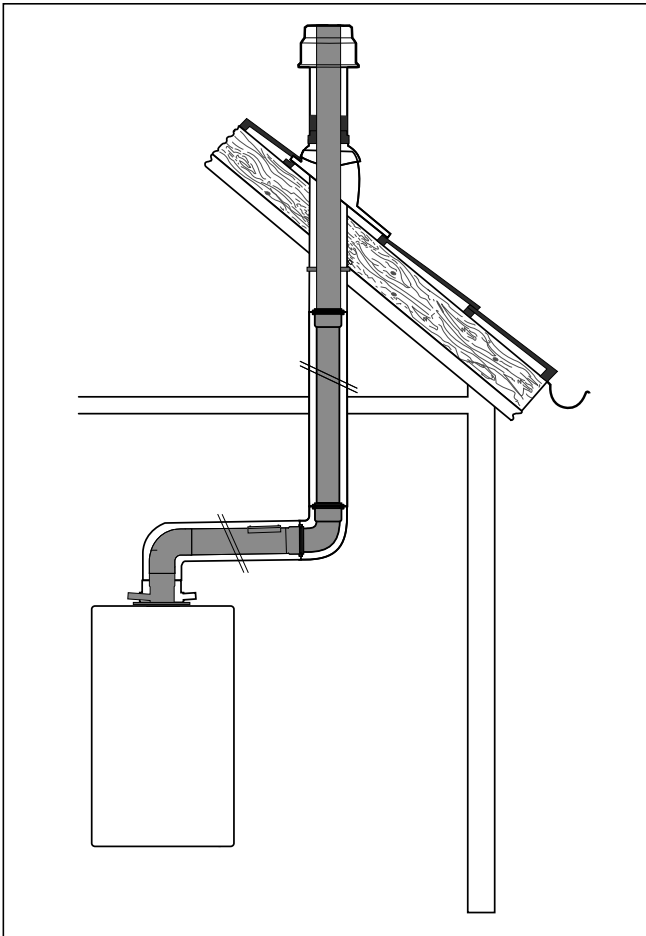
Montagebeispiel senkrechte Dachdurchführung mit Reinigungsöffnung
